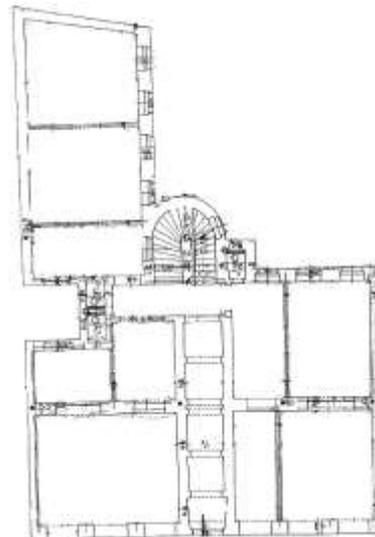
Grundriss Argentinierstraße 58
